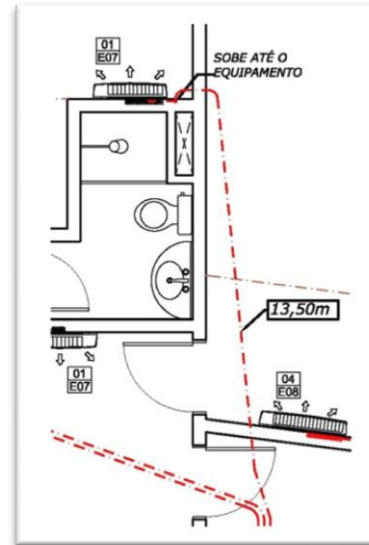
Planta baixa intersecção de dutos com paredes.
